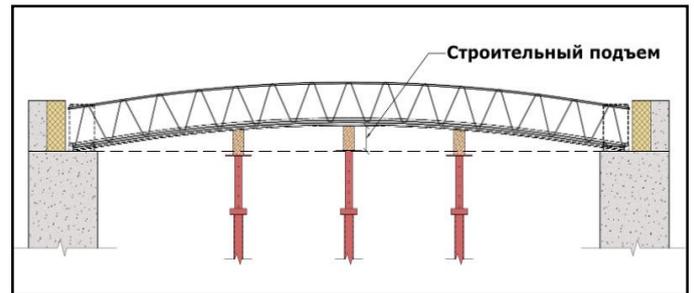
Строительный подъём—незначительный выгиб балок несъемной опалубки вверх от горизонтальной
